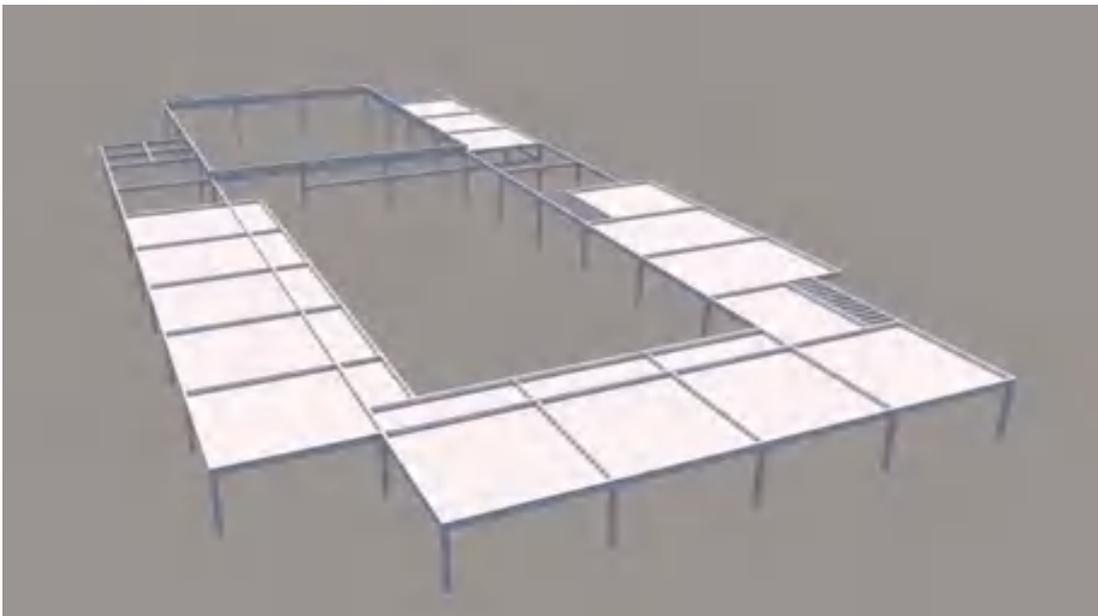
Elementos de laje pré-moldada treliçada com EPS
